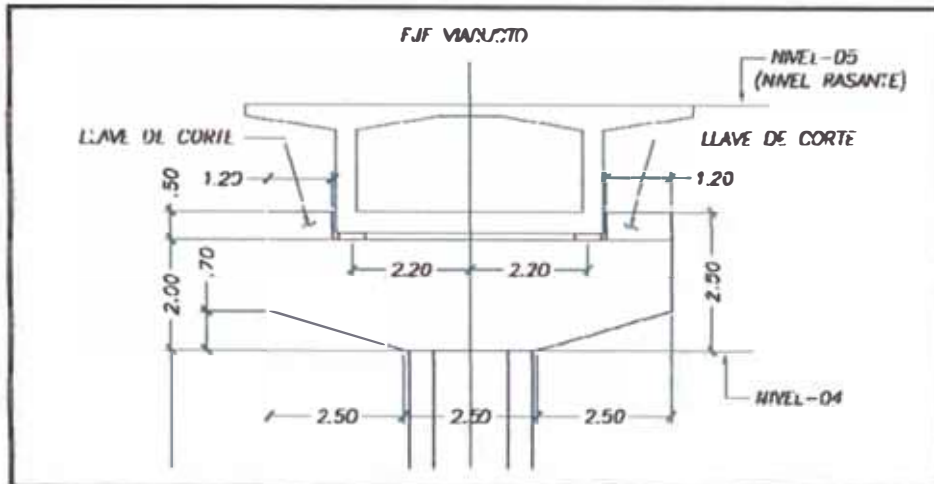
Sección transversal típica de la Viga Cabezal en Pilar S48-52
